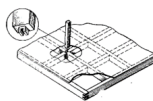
Установка чашечек для крепления стальных стержней на подмакстилке
